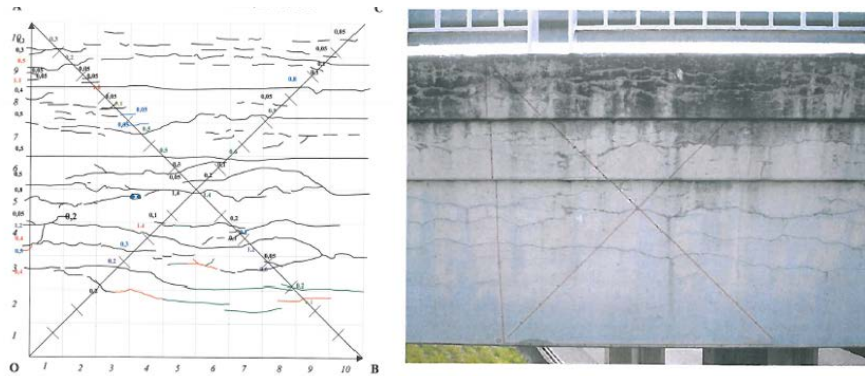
Fissures horizontales et indice de fissuration
